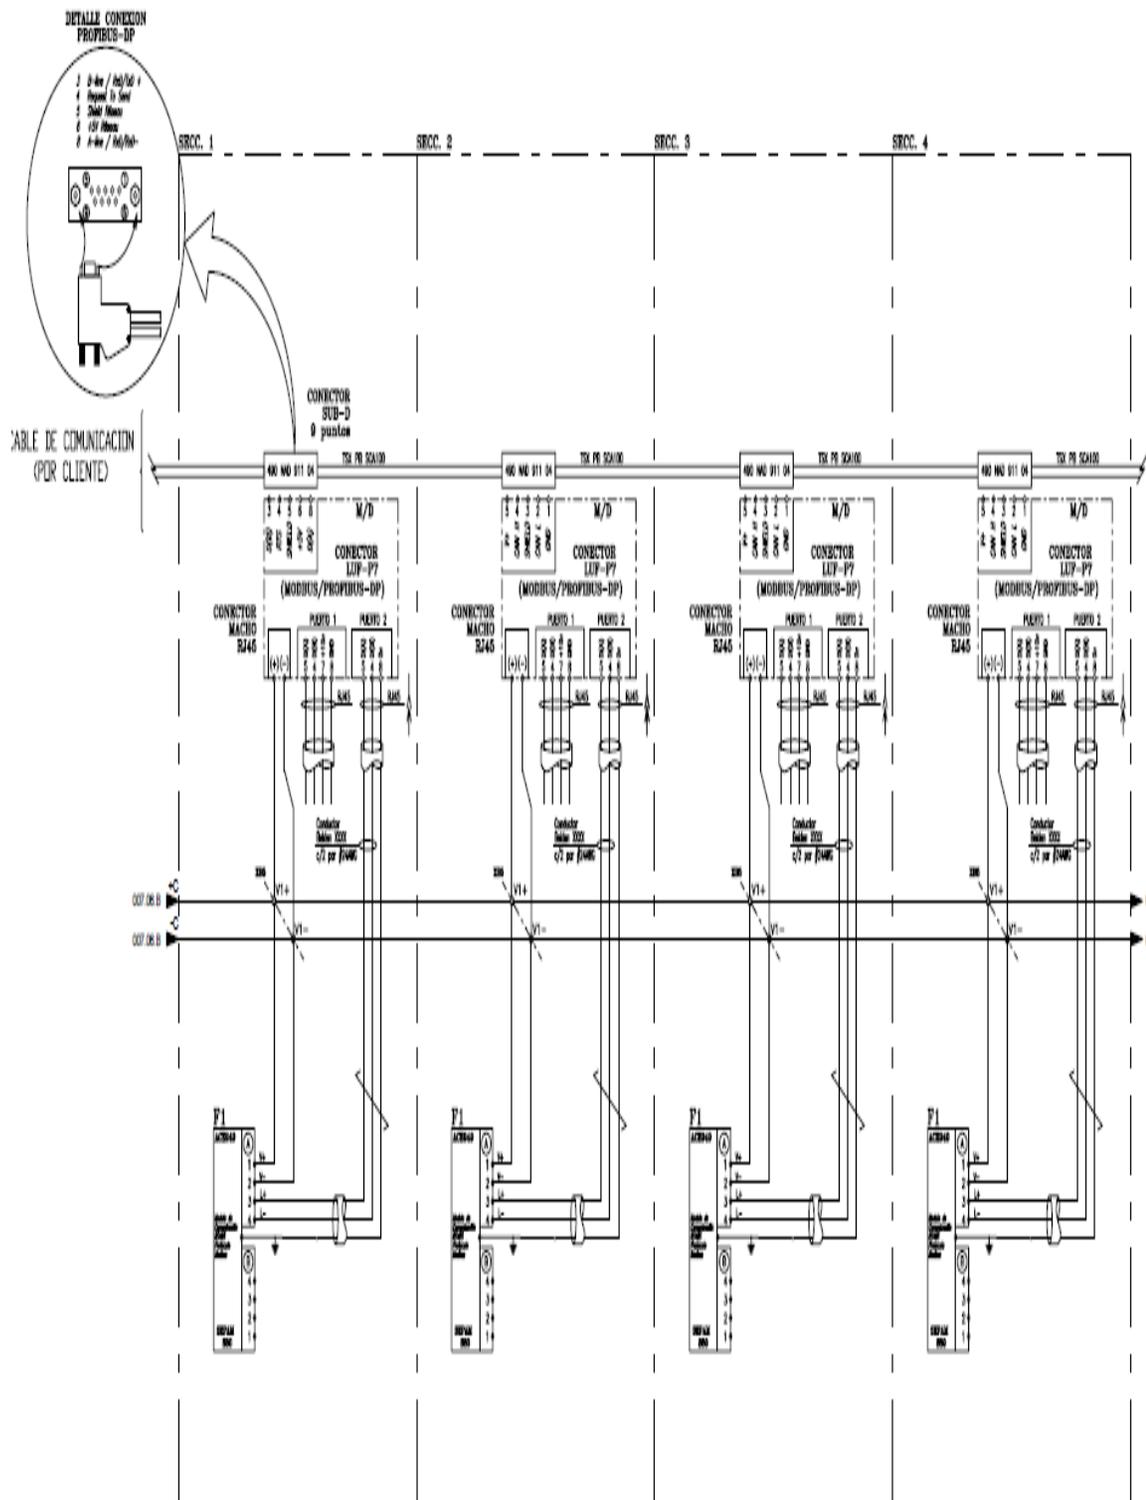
Diagrama Eléctrico de Distribución Celdas MCset en Planta Melón
